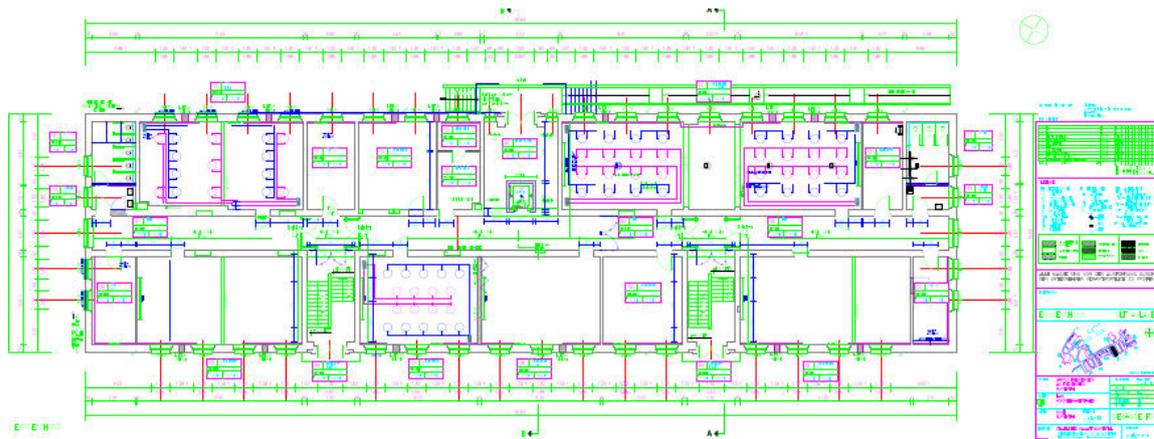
Grundrissplan Erdgeschoss, Gebäude FD
